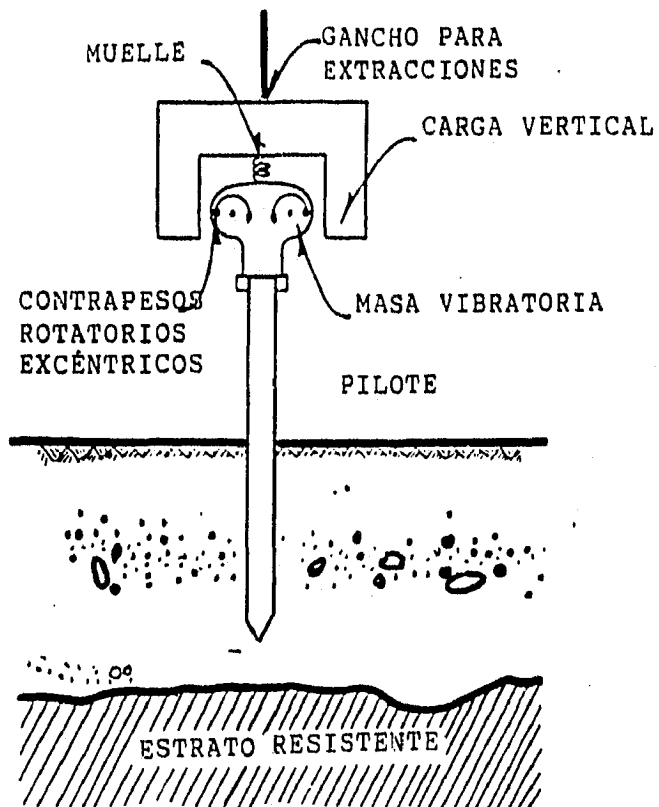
PILOTE HINCADO CON VIBRACIÓN.
